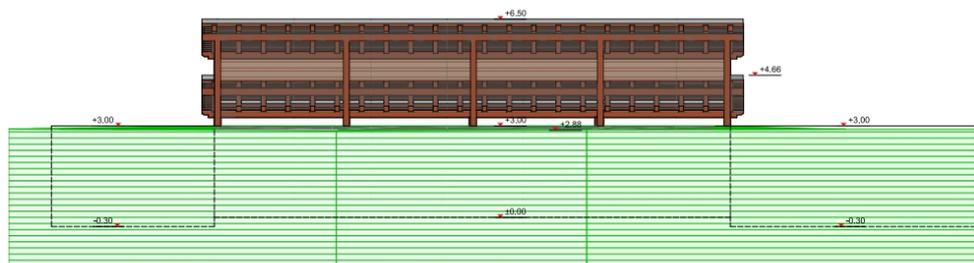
Schnitt Stallgebäude inkl. Strohlager, Planungsbüro Schatz KG
